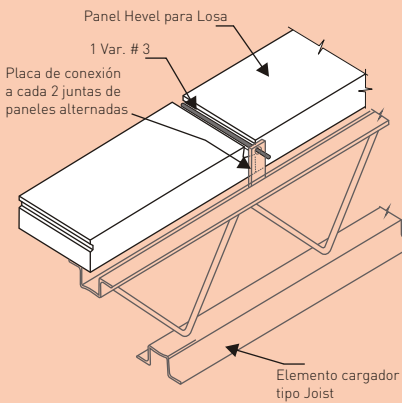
Placa de conexión en elemento cargador tipo Joist.
